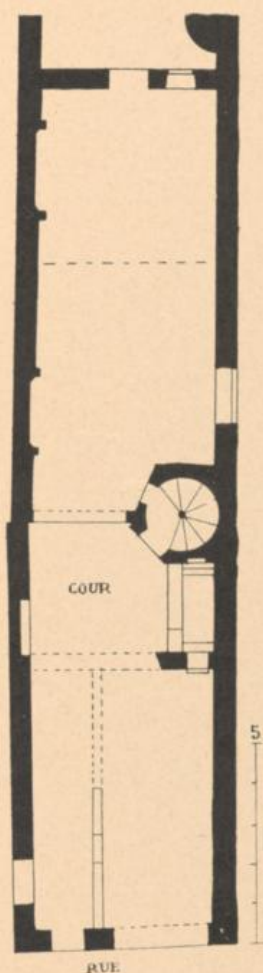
LE MANS : MAISON D'ADAM ET D'ÈVE. Plan du rez-de-chaussée
